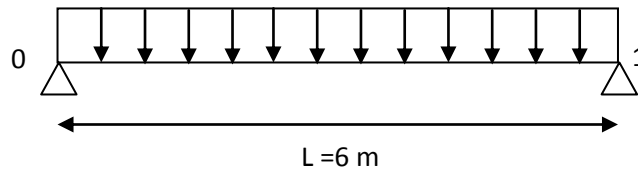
Schéma statique de la poutre d'étage courant
